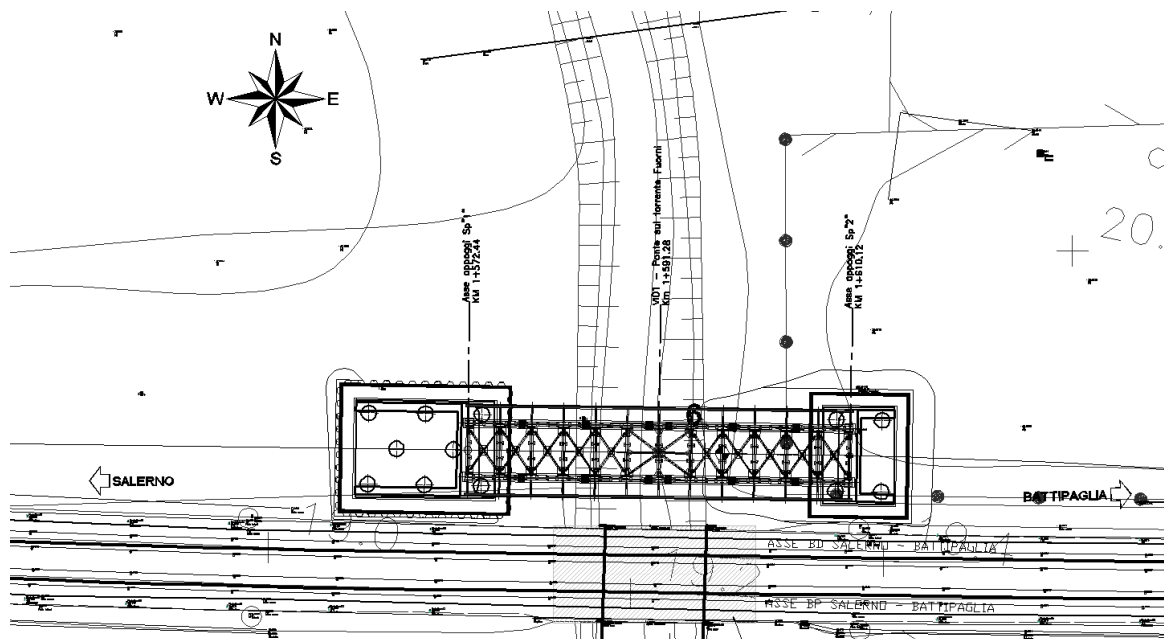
Stralcio planimetrico – ubicazione opera d'arte
